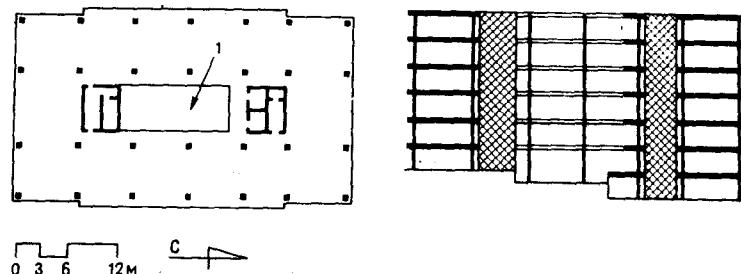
План и разрез жилого дома Фор Сизонс, землетрясение в г. Анкоридж
